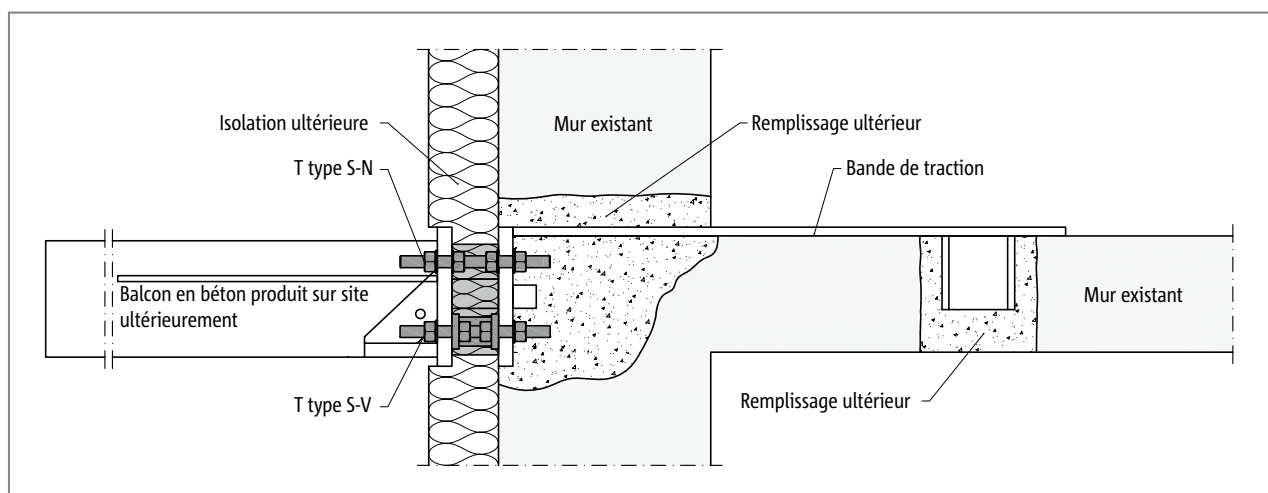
Schöck Isokorb® T type S-N et T type S-V : balcon en béton produit sur site, en porte-à-faux libre, posé ultérieurement ; relié à la dalle en béton armé existante par une bande de traction
